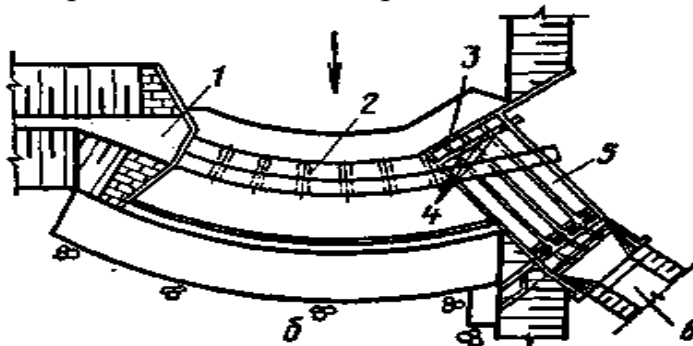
Фронтальный водозаборный гидроузел:
